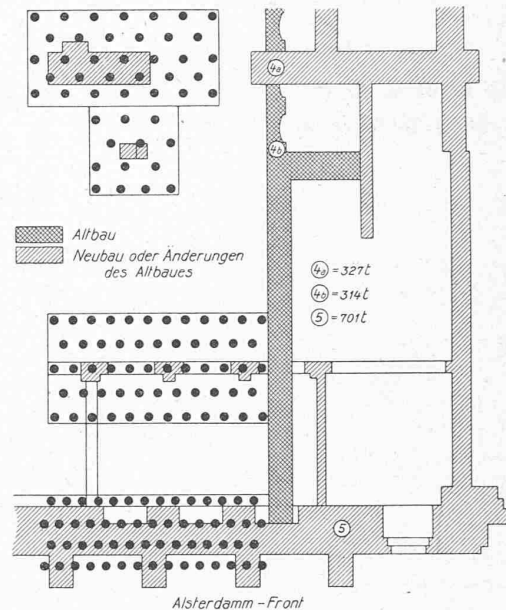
Teilgrundriss. — Masstab 1 : 250.
